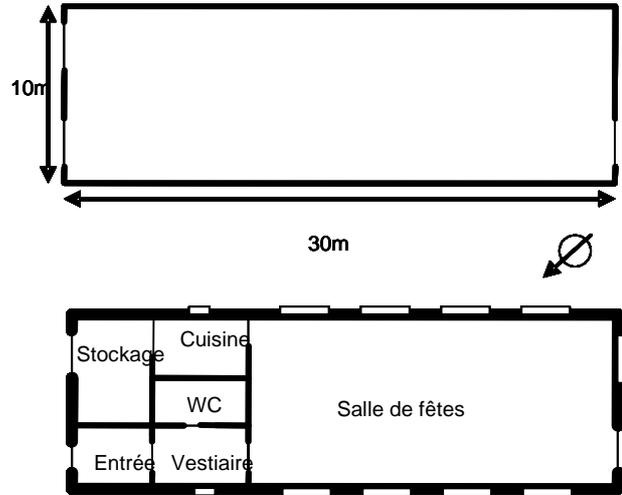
Plan du hall de stockage (au-dessus) et de la salle des fêtes (en dessous)
